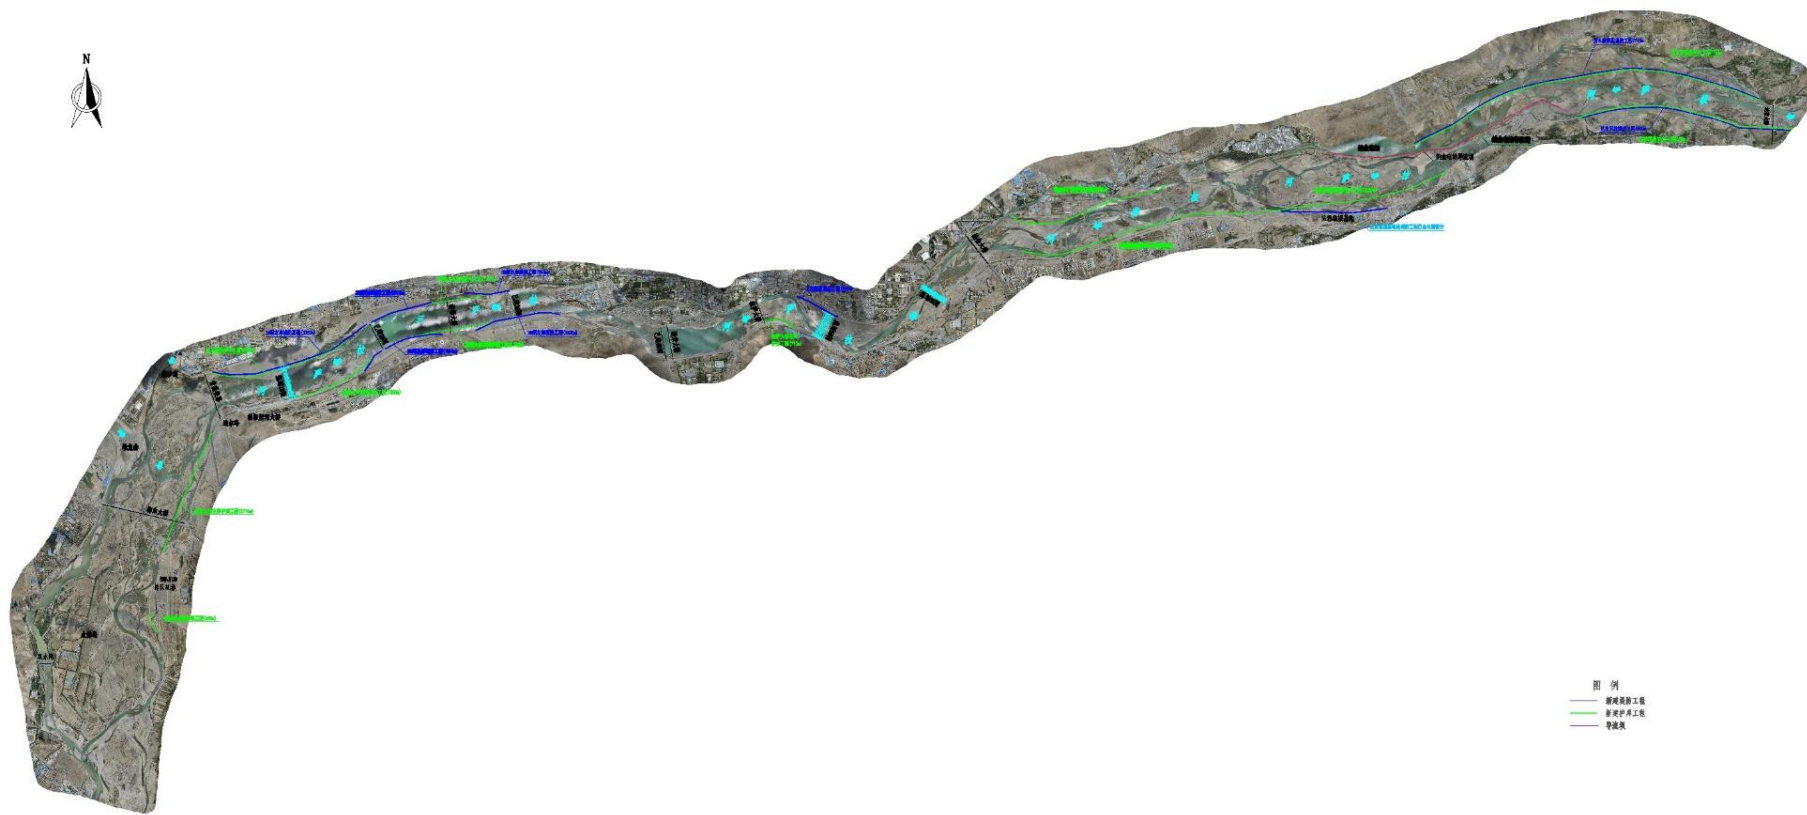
拉萨河城区段堤防工程平面布置示意图
